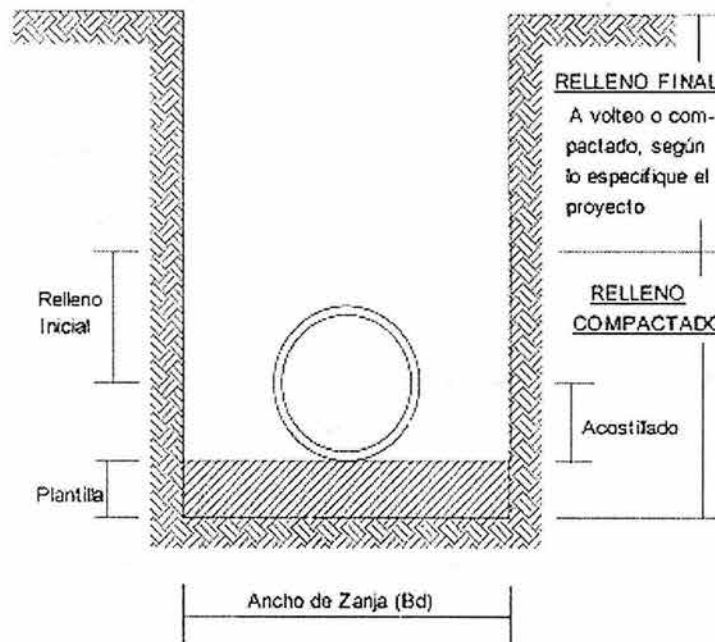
Zanja tipo para alojamiento de la tubería
